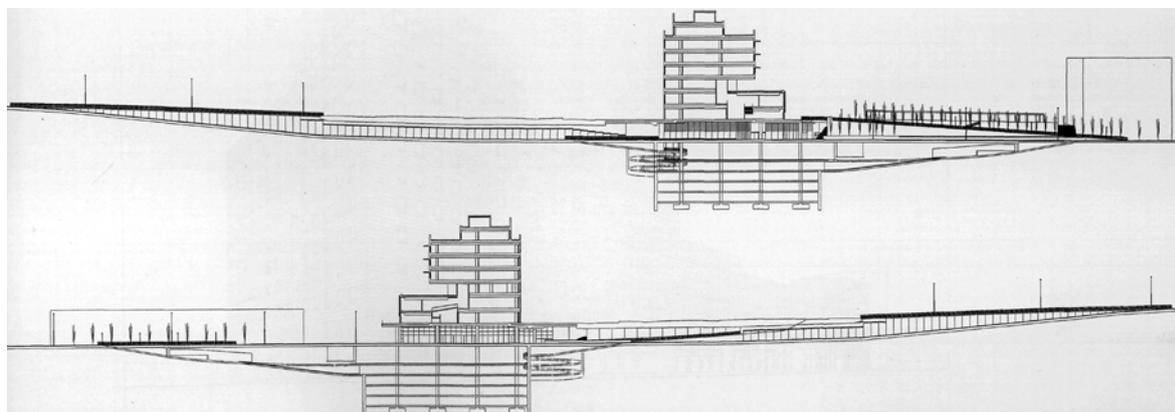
Sección por calle Constança, proyecto ejecutivo L'illa Diagonal.
